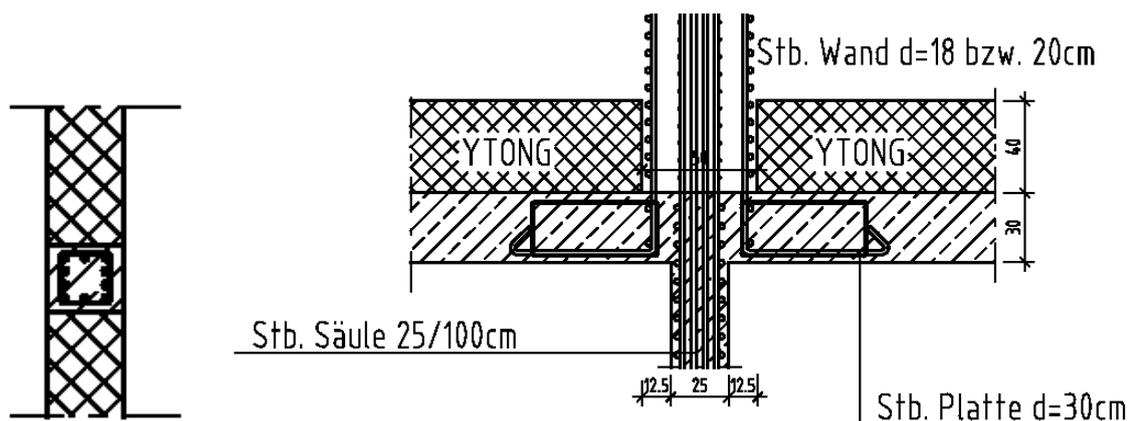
Stahlbetonlager bei Bodenplatte/ Stahlbetonlager bei Stütze [WER 05]
